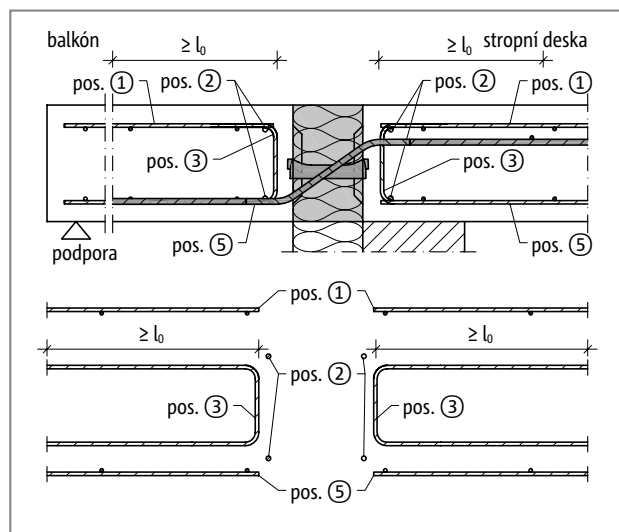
Schöck Isokorb® typ QXT10+QXT10 až QXT40+QXT40: Napojovací stavební výztuž
